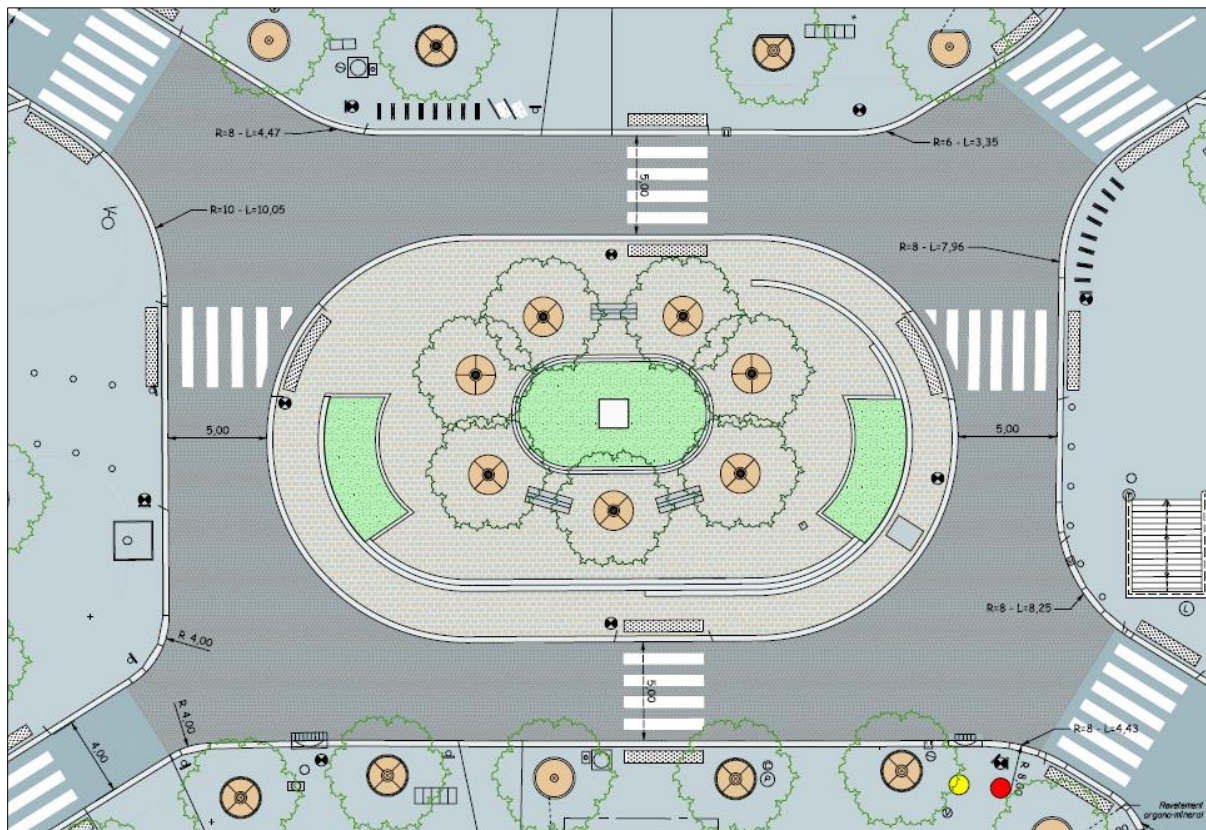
Plan du projet d'aménagement de la place Rhin et Danube
